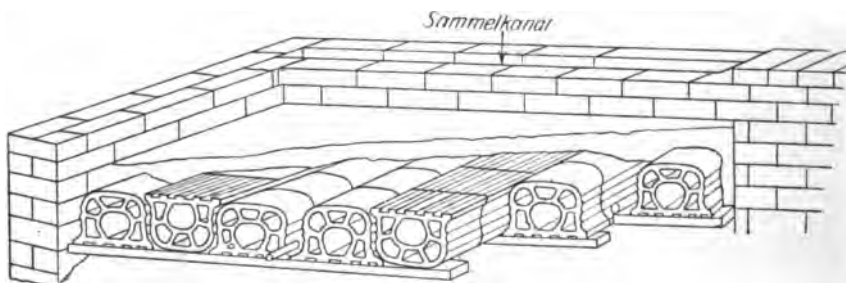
Schnitt durch die Ventilation-Tonhohlkörperdecke.
